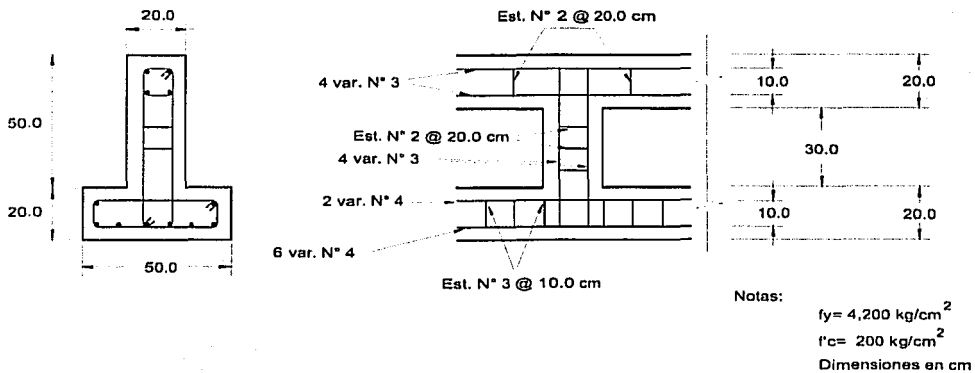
Refuerzo estructural para la cimentación propuesta
